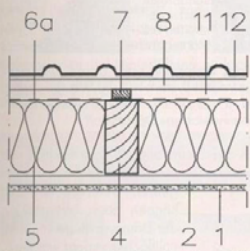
Geneigtes Dach mit extrem diffusionsoffener Unterspannbahn ($s_d \leq 0,02 \text{ m}$), ohne Dampfsperre
